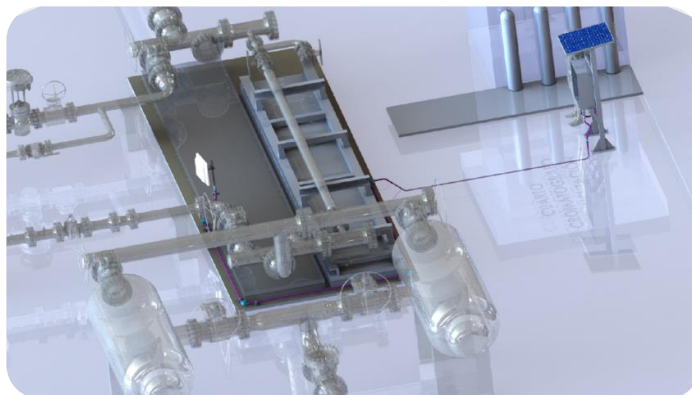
Trazado Conduit locación N.º 1. Fuente: Autor
